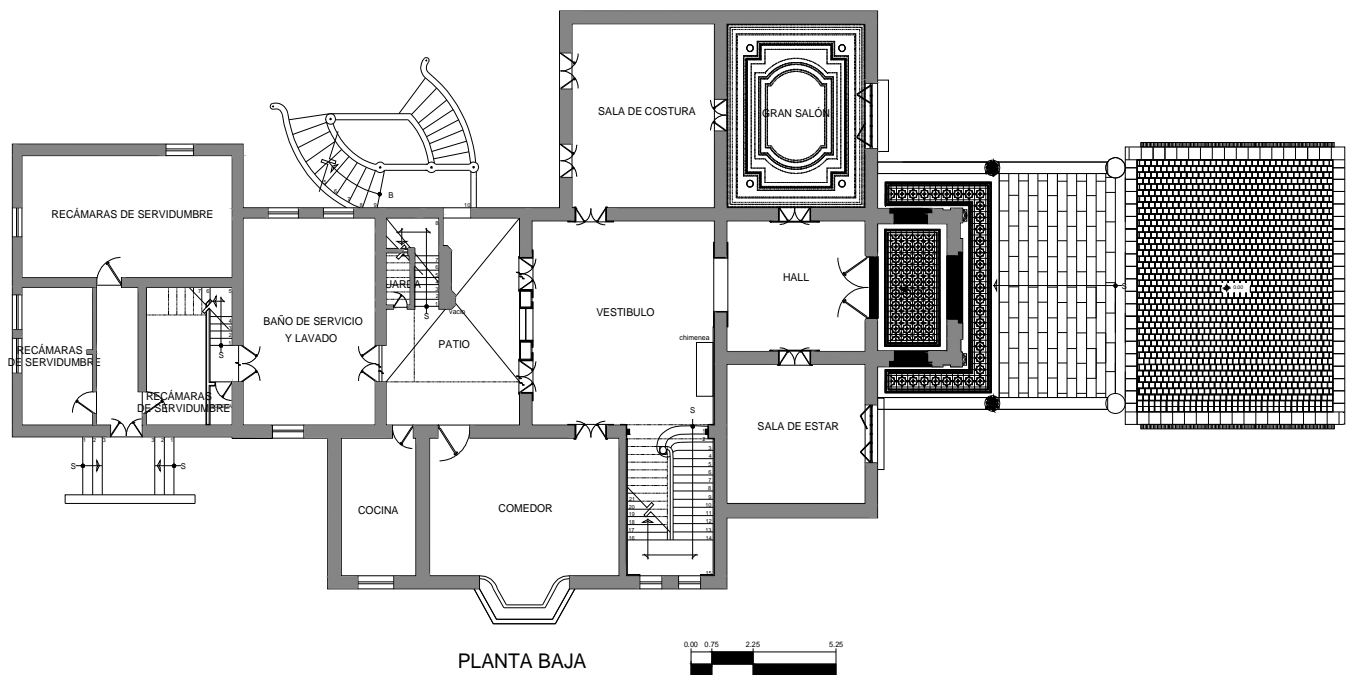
Planta arquitectónica, planta baja de la Casa Otelo.
